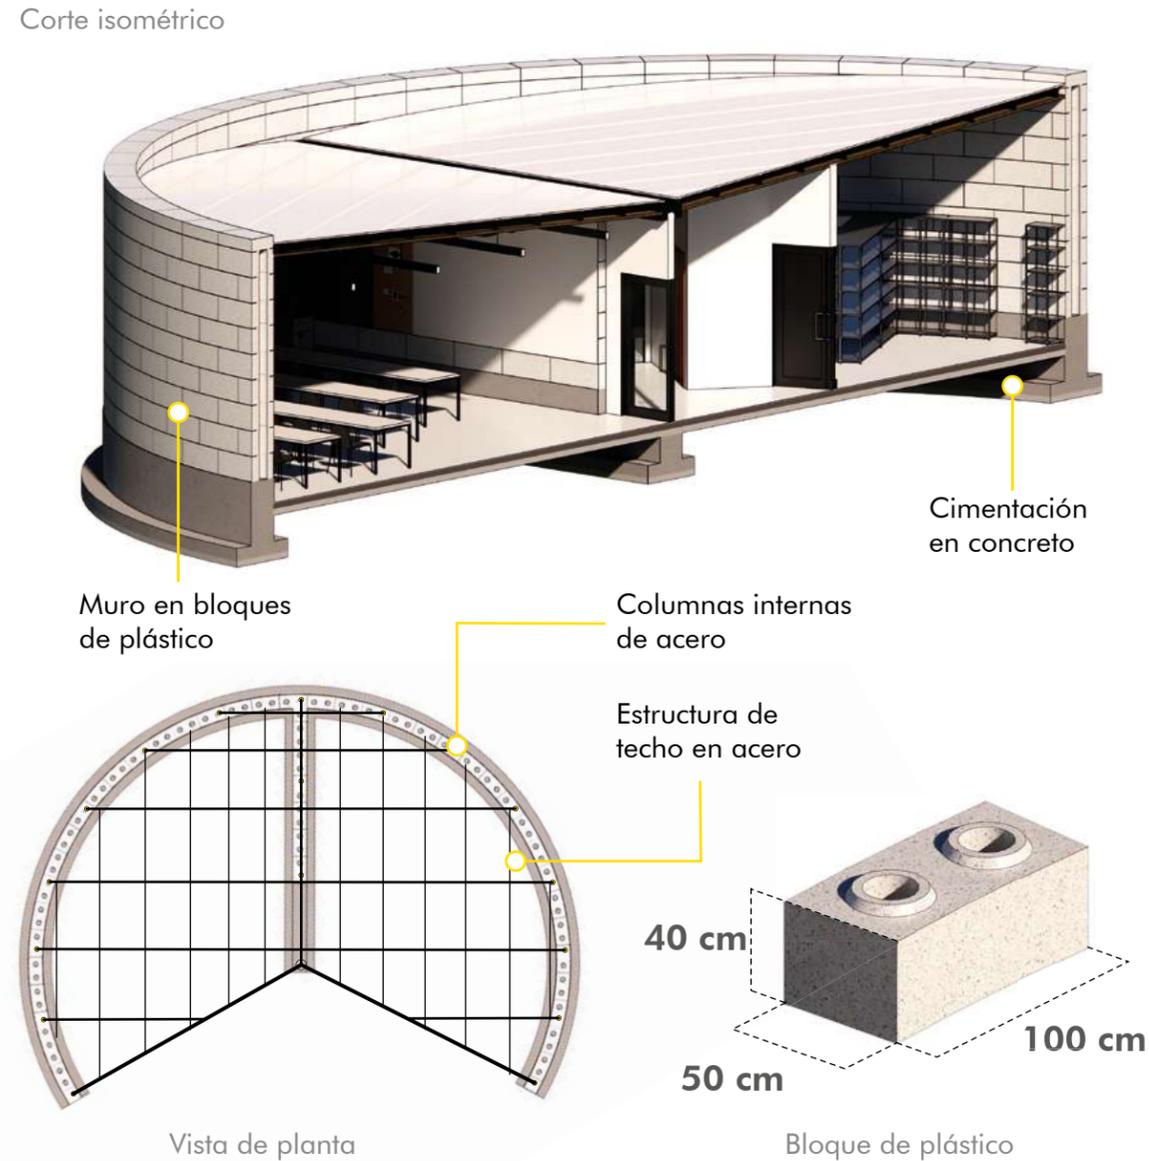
Detalles estructurales del Centro Tecnoagrícola.
